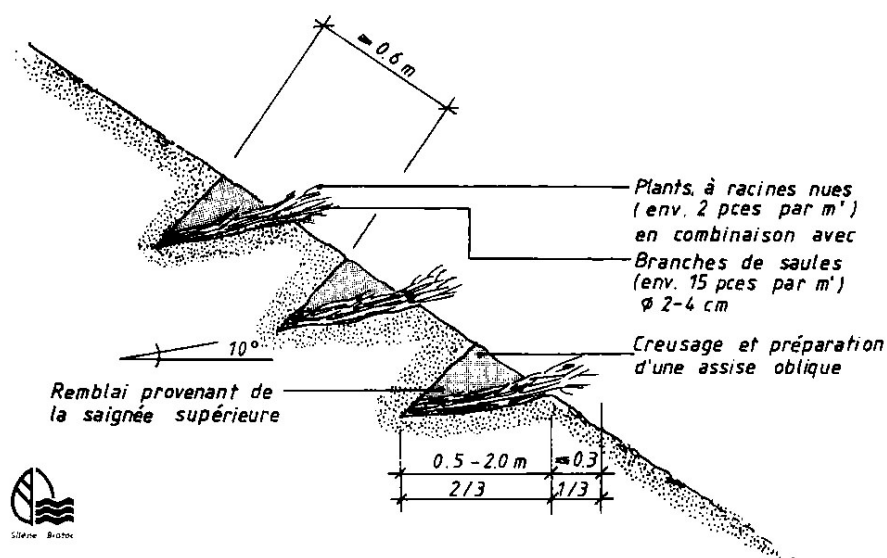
coupe-type des lits de plants et plançons (illustration extraite de Lachat [1994])
